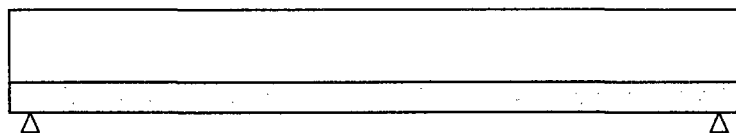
Conditions de mise en place de la dalle lors de la construction
